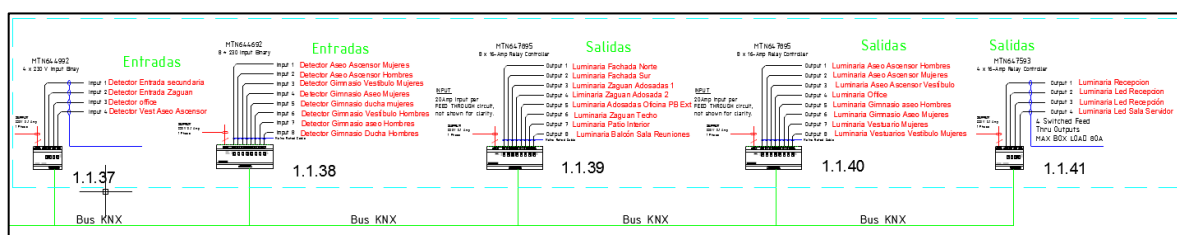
Elementos KNX de Cuadro de Planta Baja
